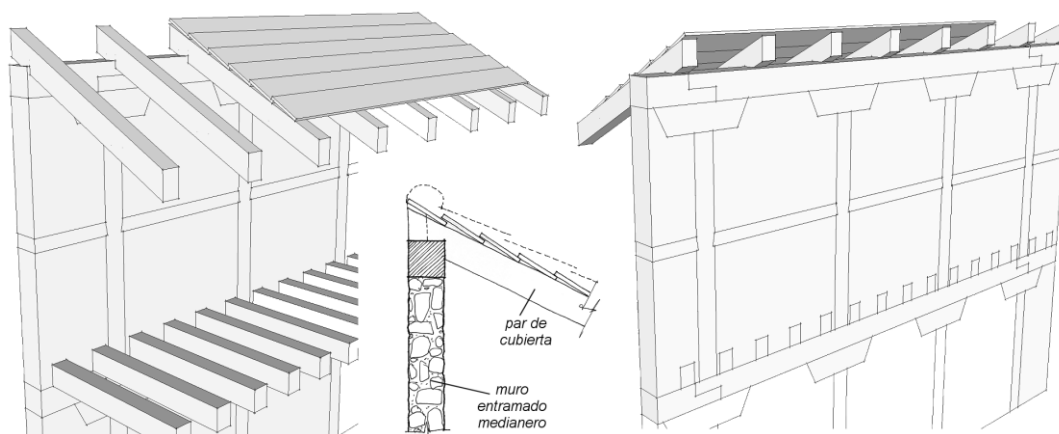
apoyo del faldón en muro de medianera (det-4)
